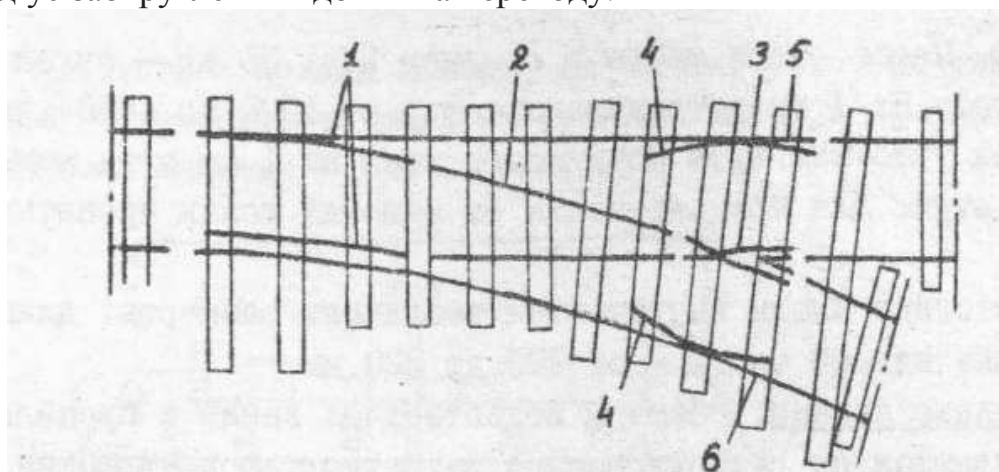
Схема стрілочного переходу: 1 - пир'я; 2 - перехідний рейок; 3 - хрестовина; 4 - контррейки; 5 - рейки прямого шляху; 6 - рейки відгалуження
